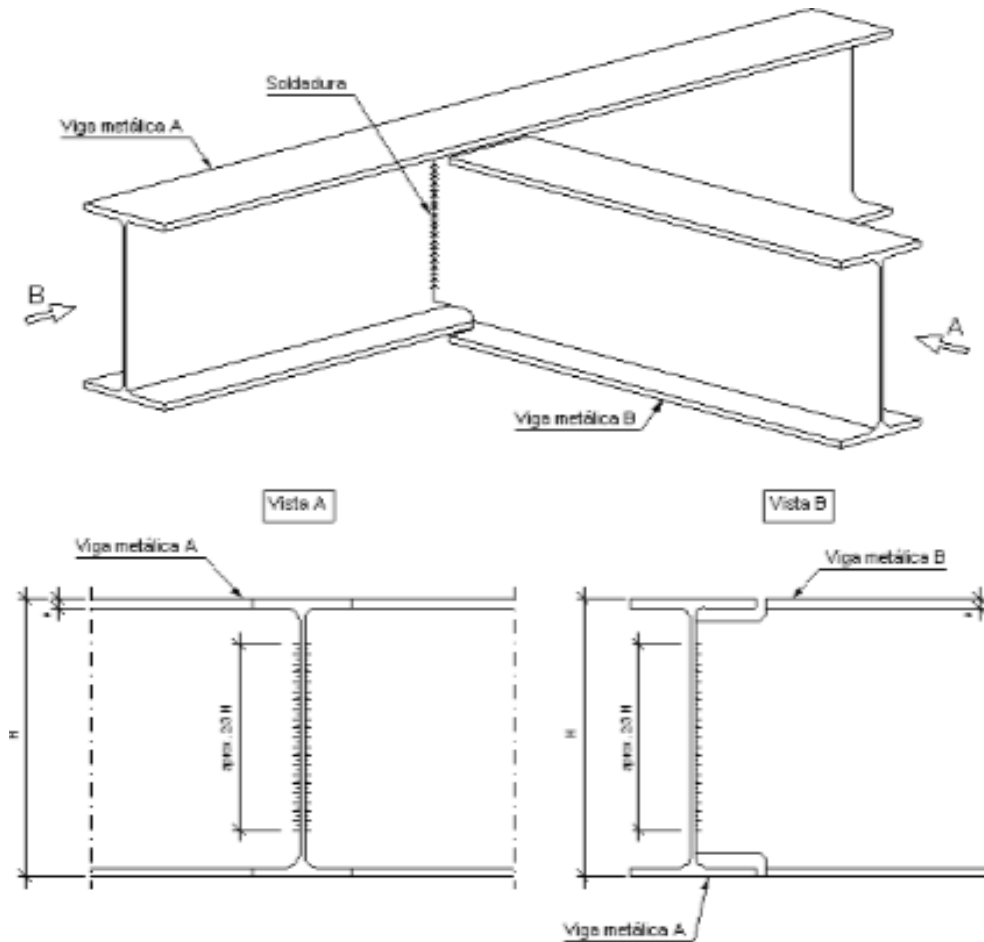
Método de unión de vigas entre sí. Detalles constructivos Cype.
